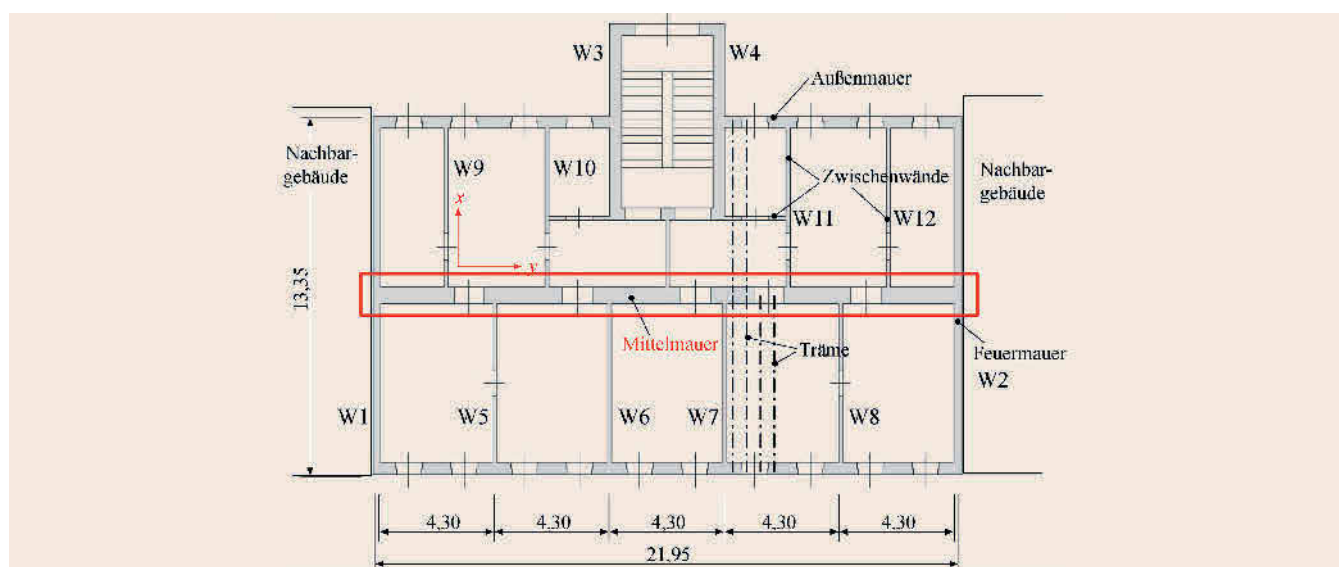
Grundriss des Wiener „Gründerzeit-Mustergebäudes“, modifiziert übernommen aus [5], [28].
